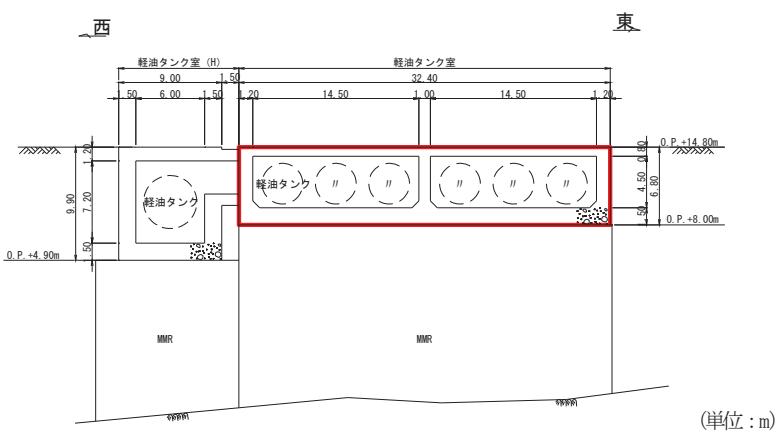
軽油タンク室断面図 (B-B, タンク室)
